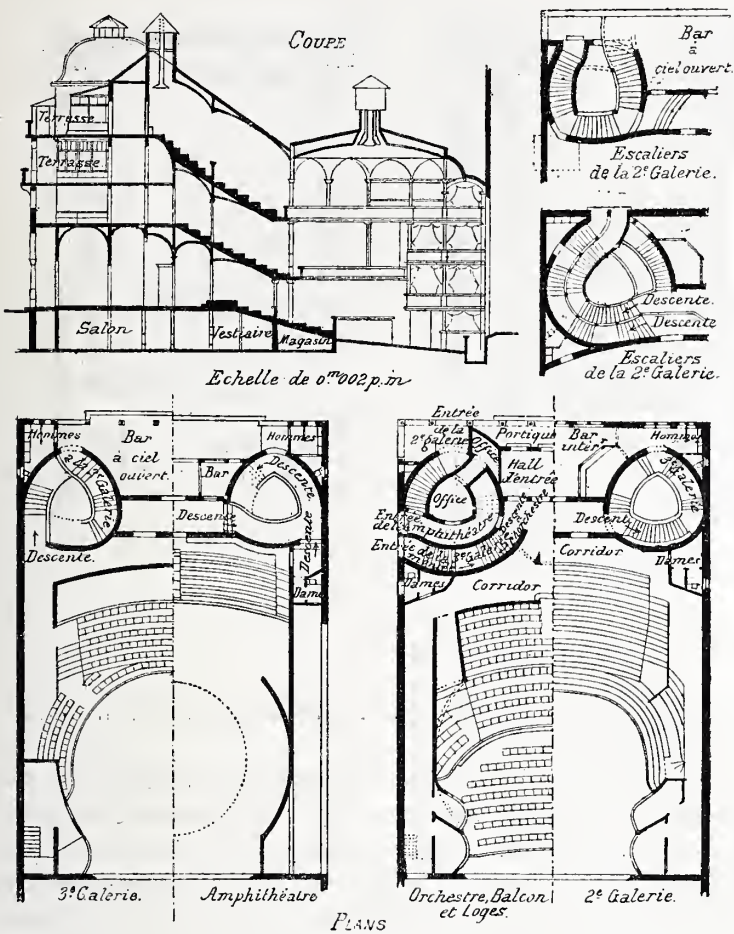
Dégagements et escaliers. Type de M. R. Newill.
